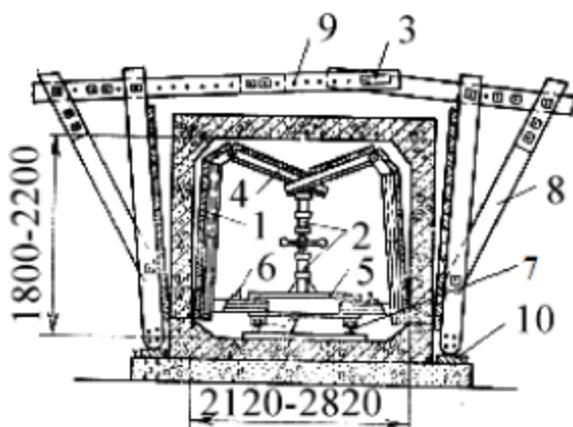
Катучая опалубка для бетонирования прямоугольного туннеля (разрез):
